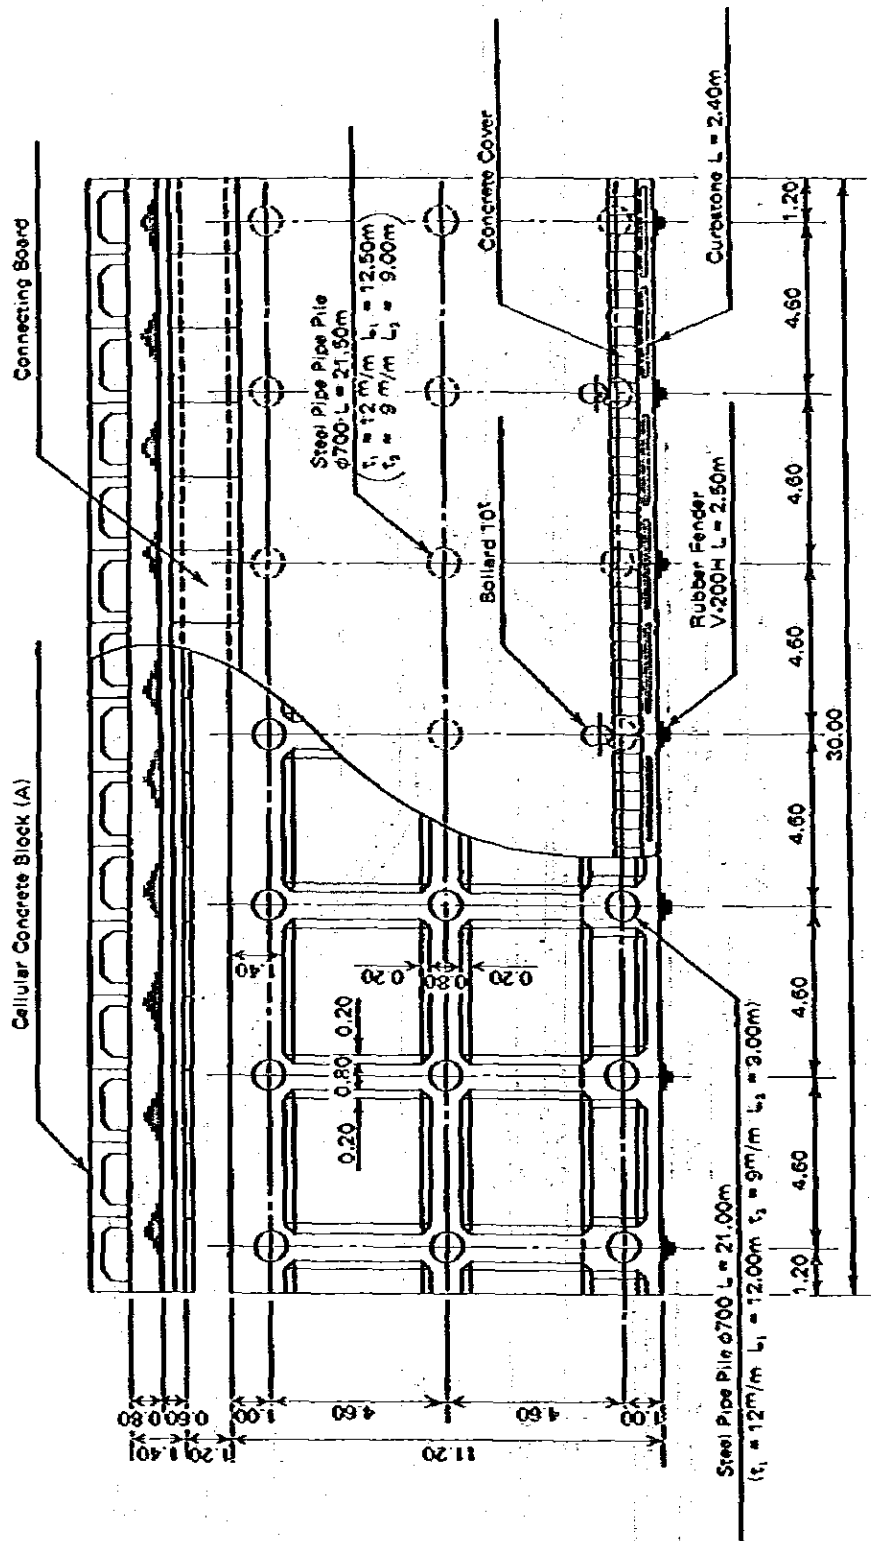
橋樑 (カンブングバル) 標準断面図と平面図
